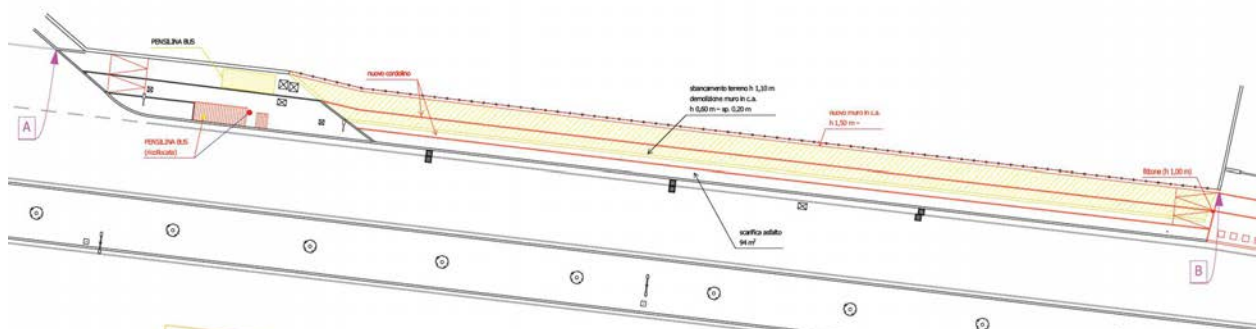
estratto Tav 6.7 - TRATTO AB
